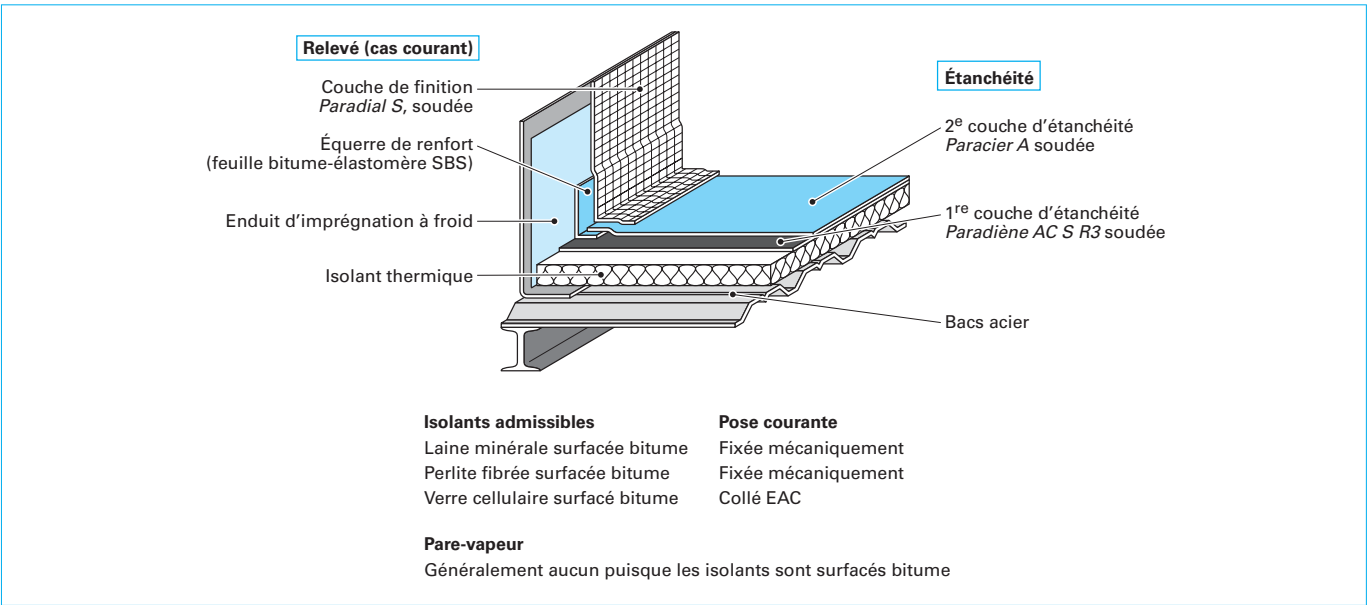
Toitures et terrasses inaccessibles sur bacs en acier et isolant
